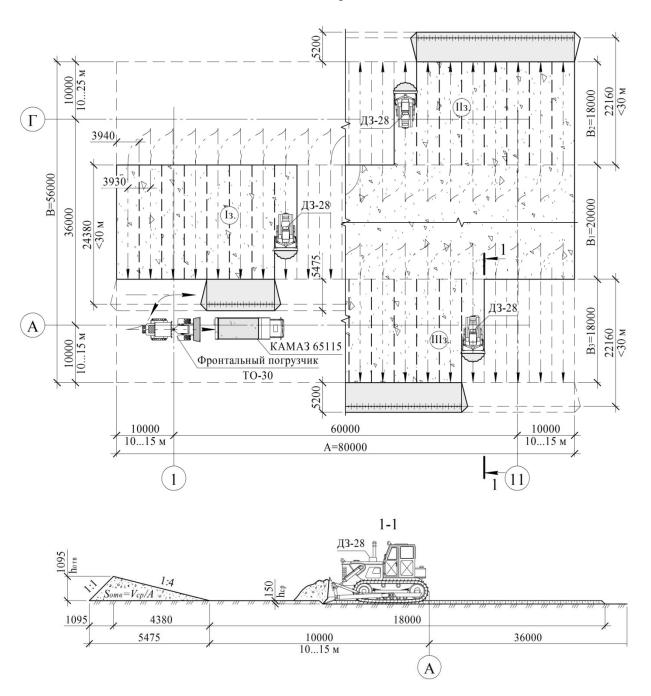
Примерная схема срезки растительного слоя грунта
